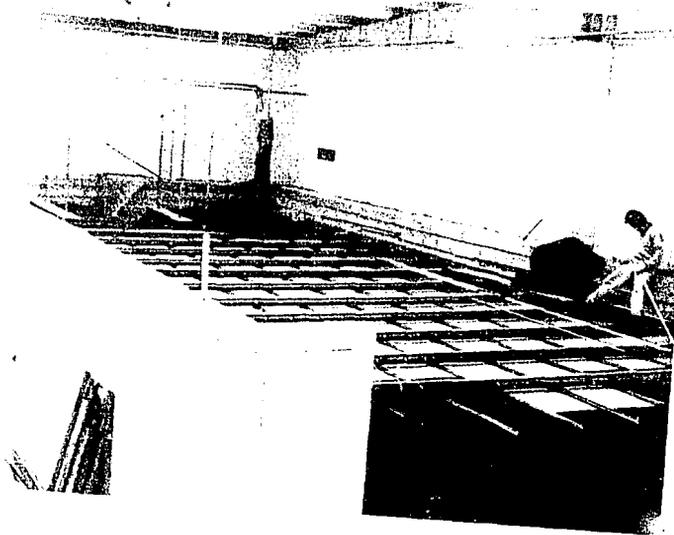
COLOCACIÓN DE PLAFÓN EN LA TORTILLERÍA.
